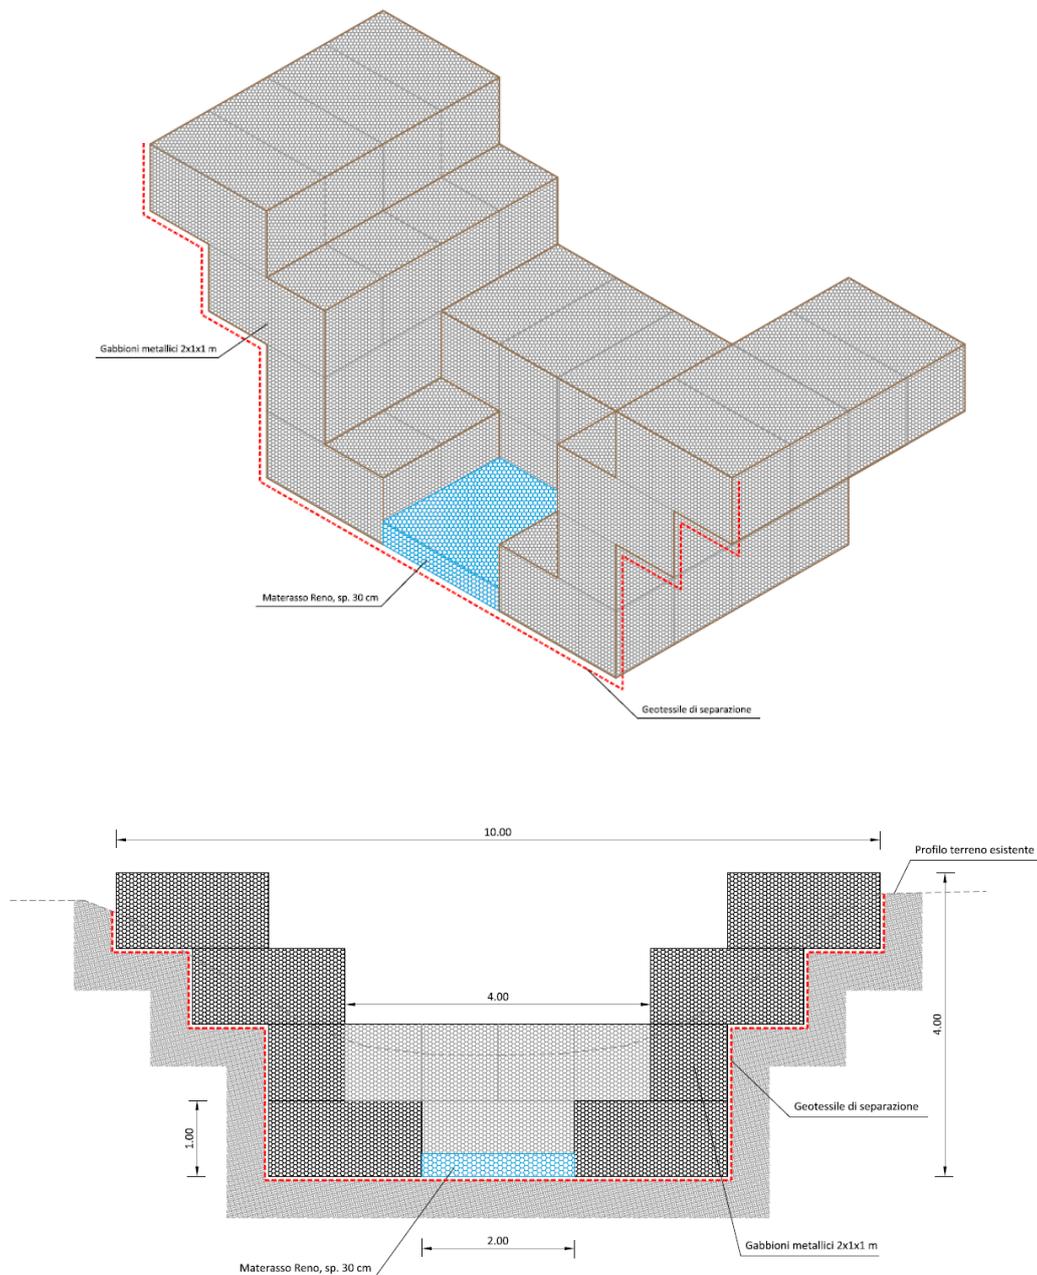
sezione del fosso estratta dall'elaborato "Opere di regimentazione idraulica_Sezioni e particolari"
